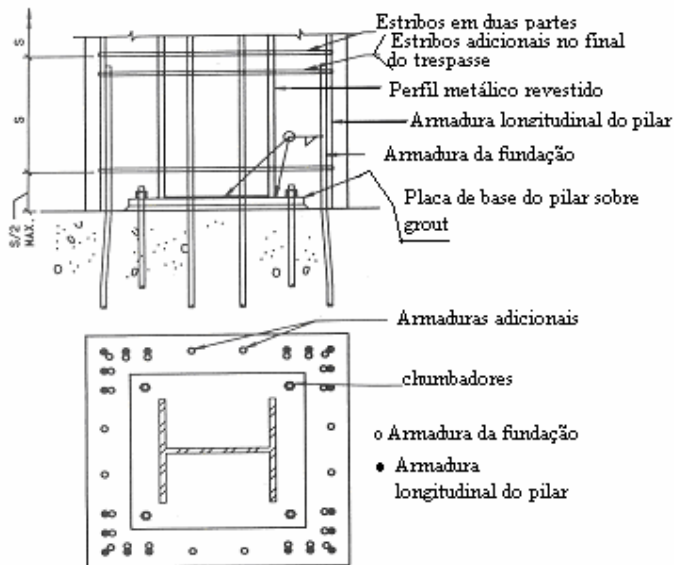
ZIC -Base de pilar misto revestido. Fonte: AISC - Steel Design Guide.
